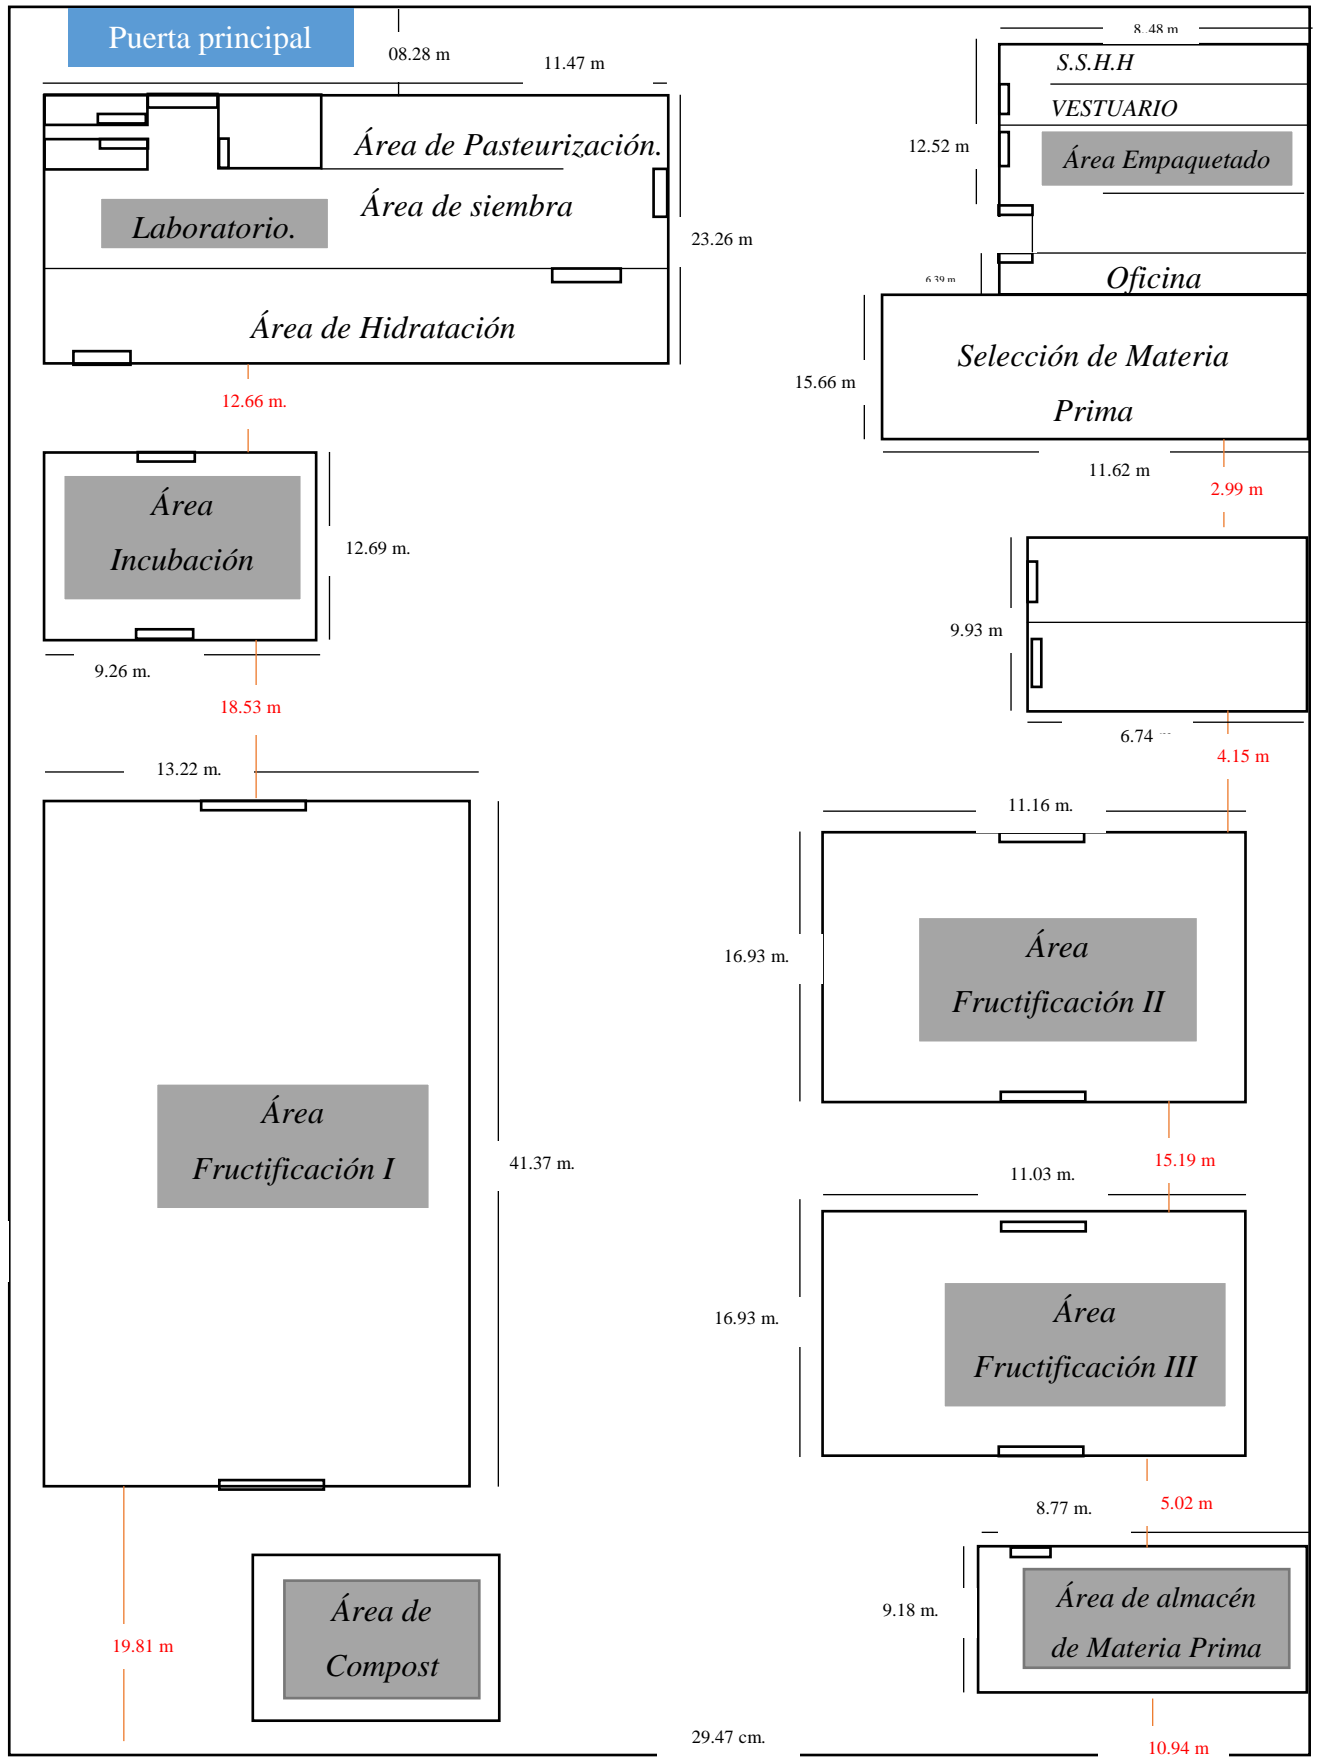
Plano de distribución de áreas de la empresa K'allampas SAC
